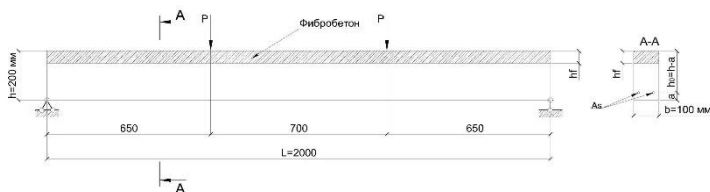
Зональное армирования фиброй в верхней грани балки на высоту h_f
